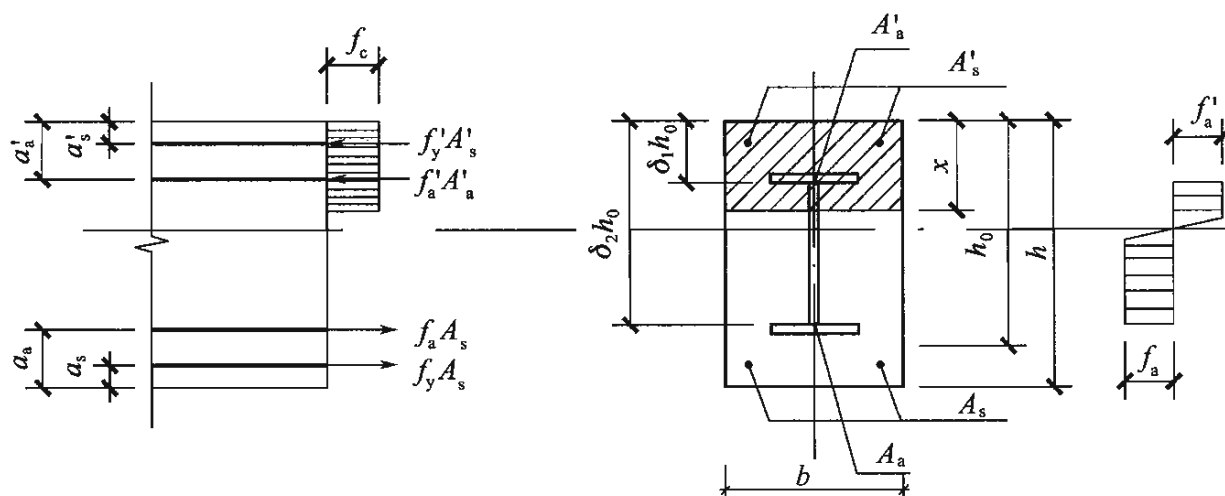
中和轴经过型钢腹板充满型实腹型钢混凝土梁受弯承载力计算简图
